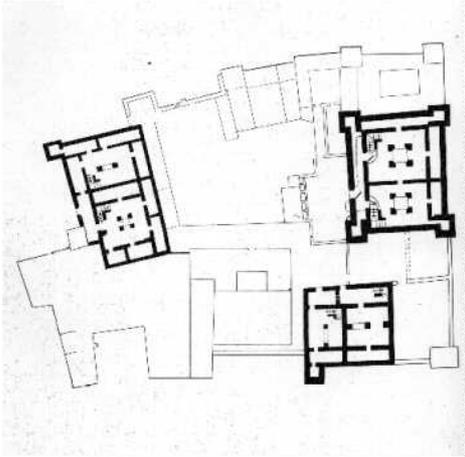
Plan básico de un Ksar, configurado por una ancha plaza central, con cuatro torres de 15 metros de altura. Las estructuras se repiten configurando las Kasbahs, ejecutadas en tapia, adobes de paja, y cubiertas de tierra con troncos de palmera como elemento de entramado.
